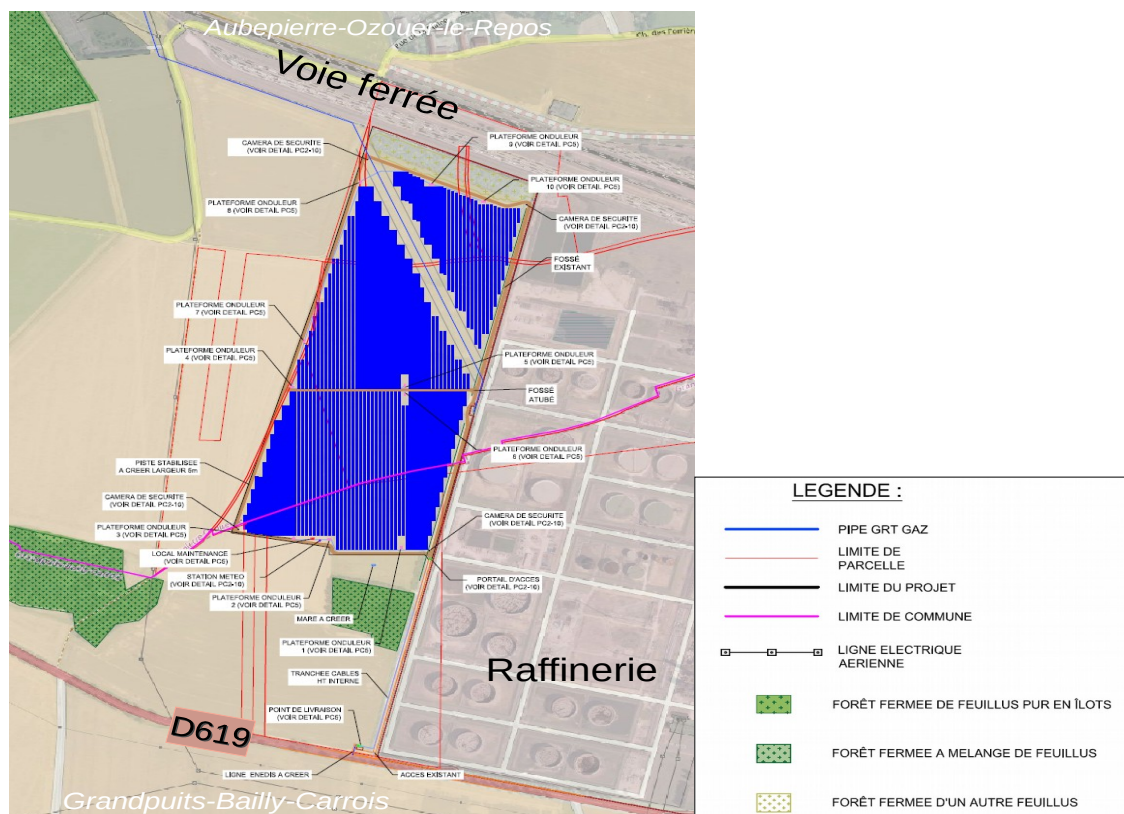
Plan masse du parc photovoltaïque (source : étude d'impact, page 161, annotations : DRIIE)
